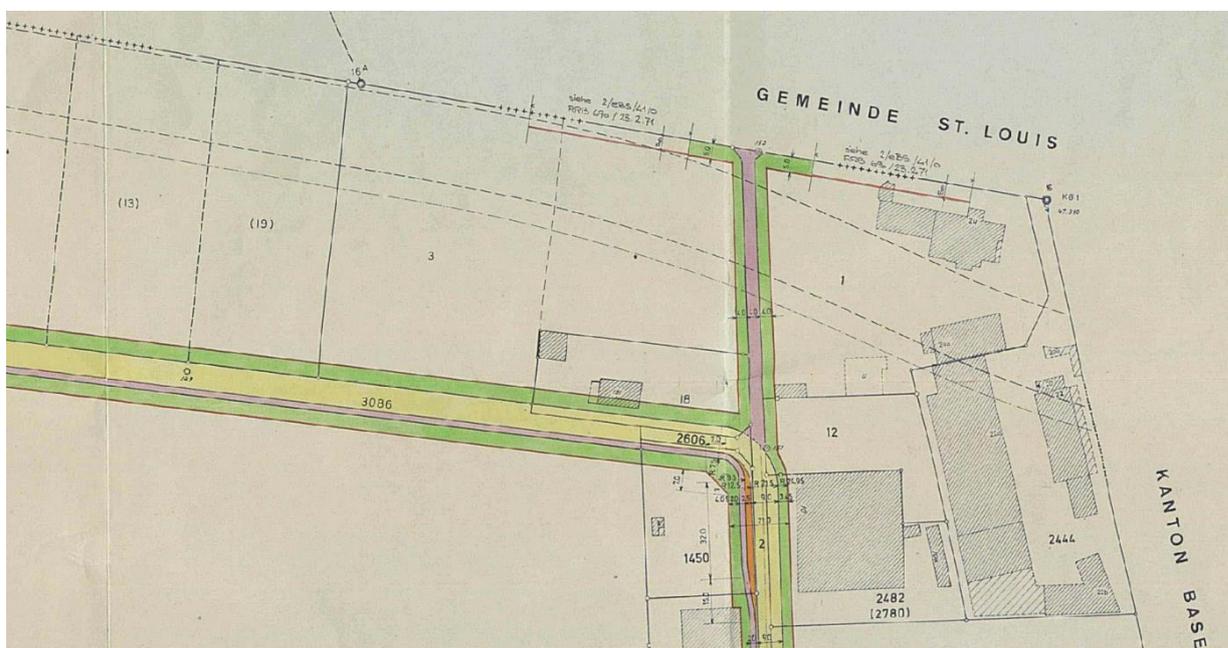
Ausschnitt aus dem BSP «linksufriges Bachgrabengebiet» (02/eBS/72/00)
